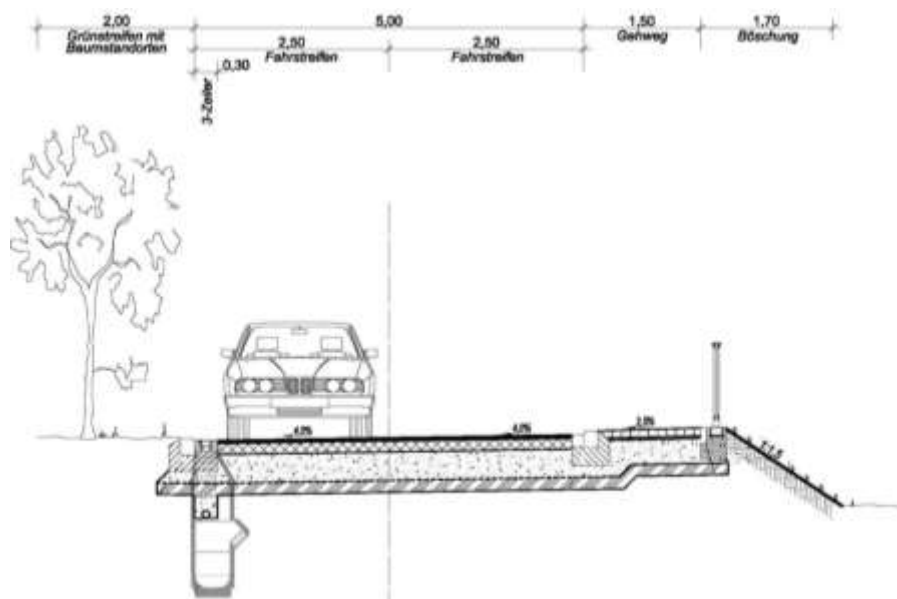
Schnitt Haupteerschließungsstraße aus Verkehrsplanung (Anlage 2 Verfasser: CIC Bauingenieure GmbH Dresden)
